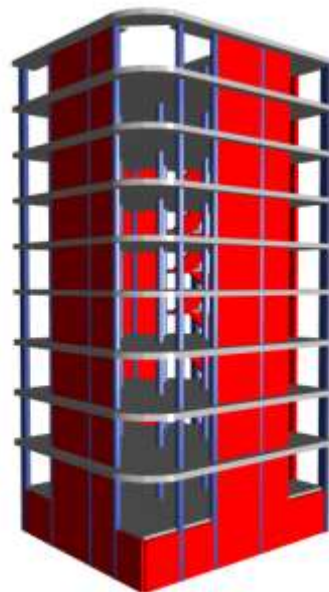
Vista en 3D estructura reforzada- Etabs v.18.
